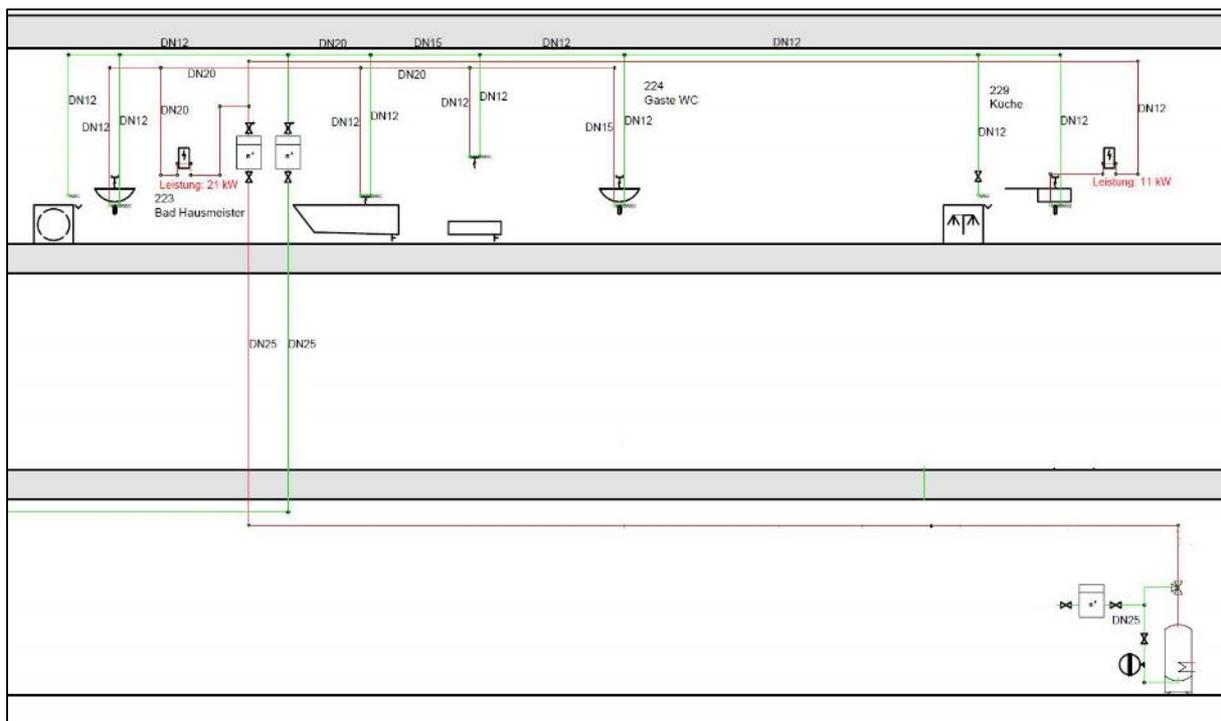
Strangschema Trinkwasser – Ausschnitt Hausmeisterwohnung
